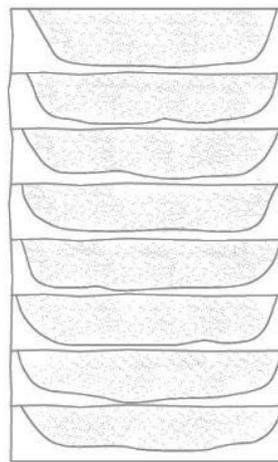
Detalle de sección de un muro de tapia calicostrada.
